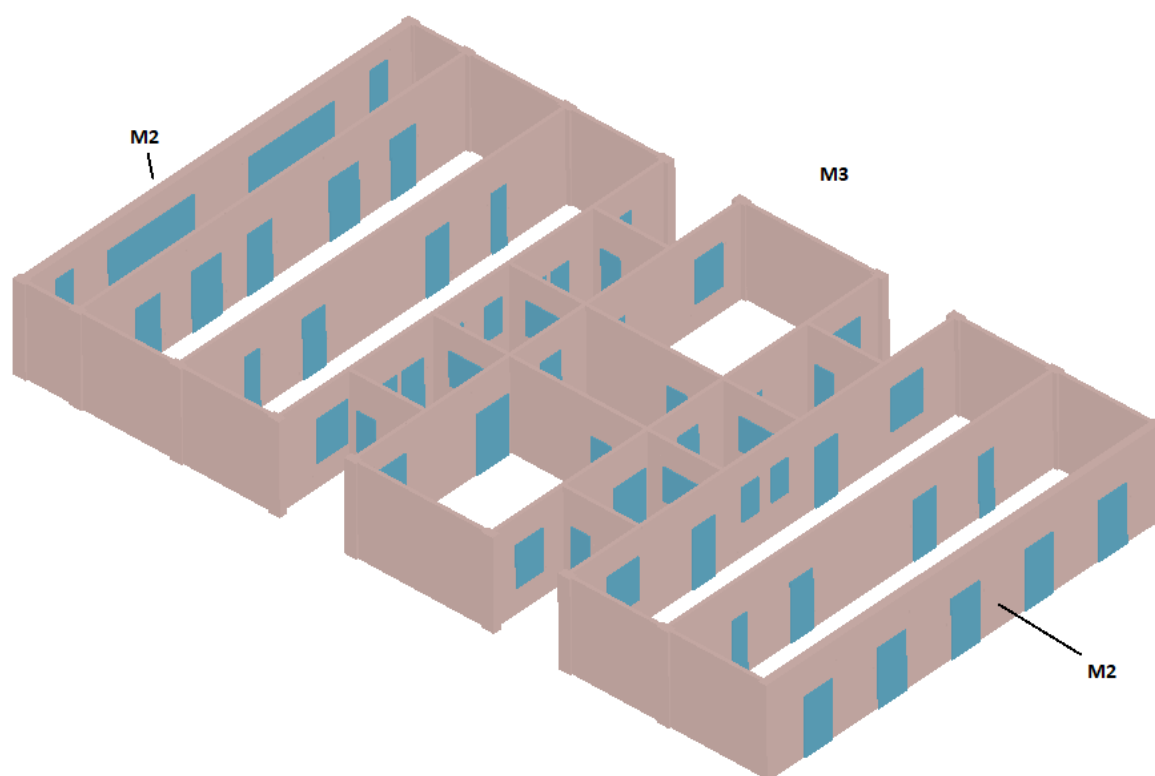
Distribución de muros de la planta tipo, todos los muros son de 15cm excepto las dos fachadas de 30cm cada uno
